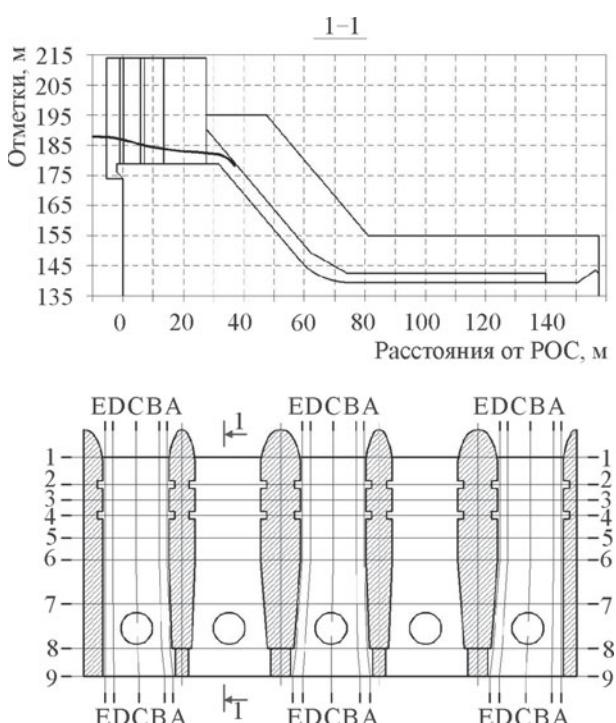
Продольный профиль и план водосброса № 2 строительного периода Богучанского гидроузла
